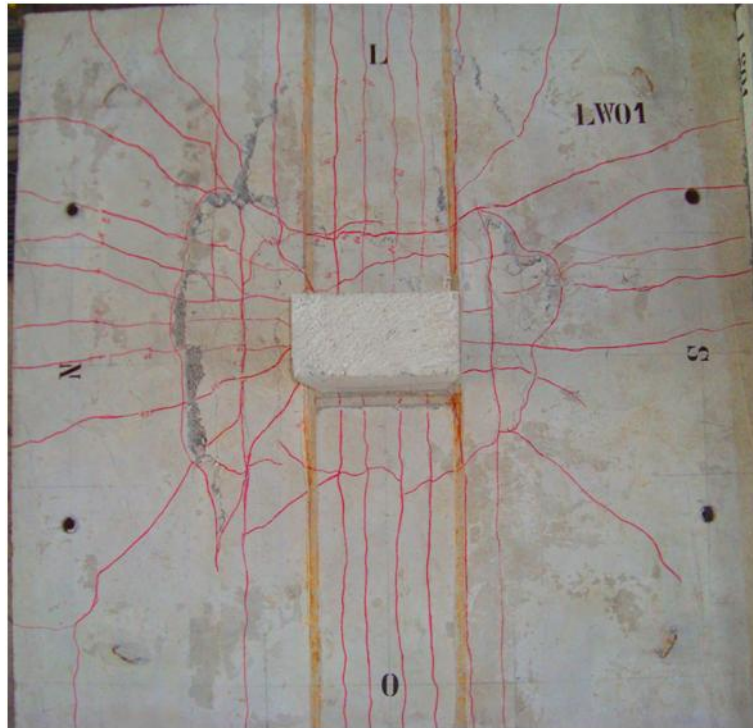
Padrão de fissuração do modelo LW01.
